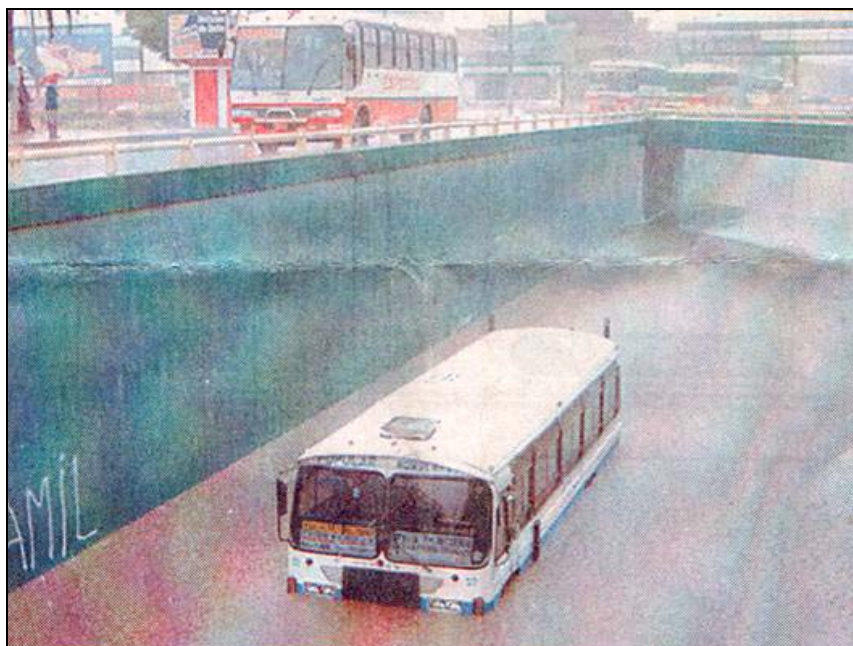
L'envolement d'un passage surbaissé au niveau de l'aéroport.
